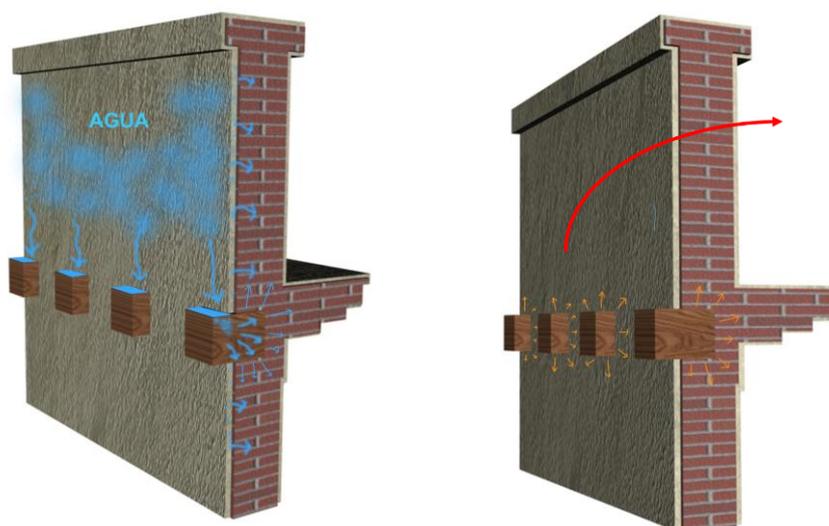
Efecto cuña de las viguetas y vuelco del muro
